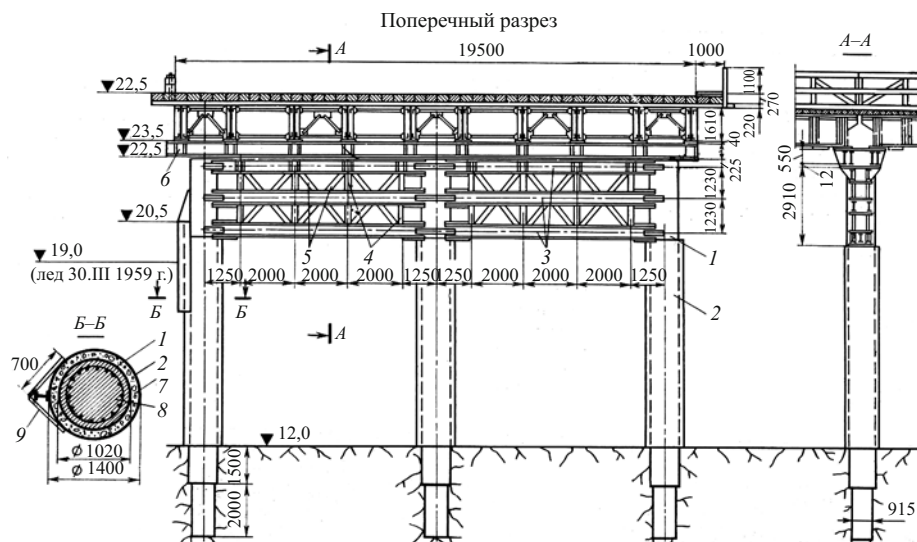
Конструкция опоры моста на заанкеренных в скалу железобетонных сваях в стальной оболочке для фронтального перекрытия р. Ангары
